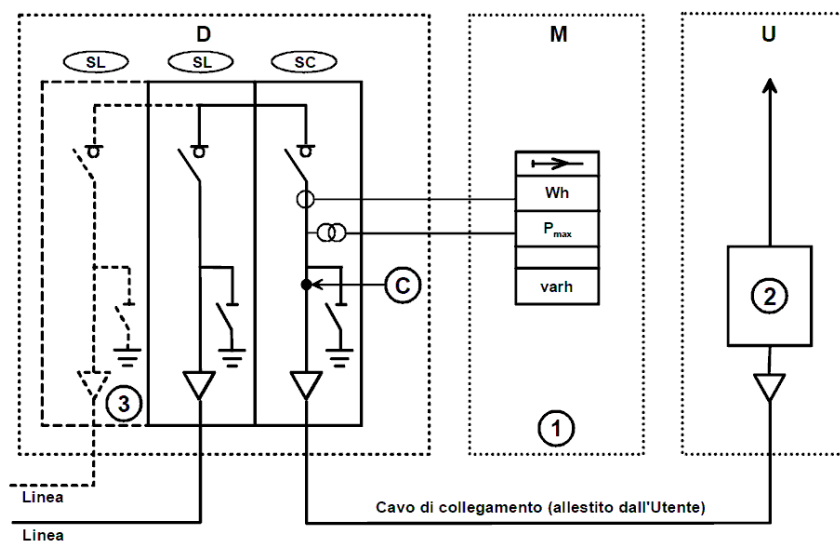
Schema di collegamento fra la cabina consegna e impianto di Utente passivo
